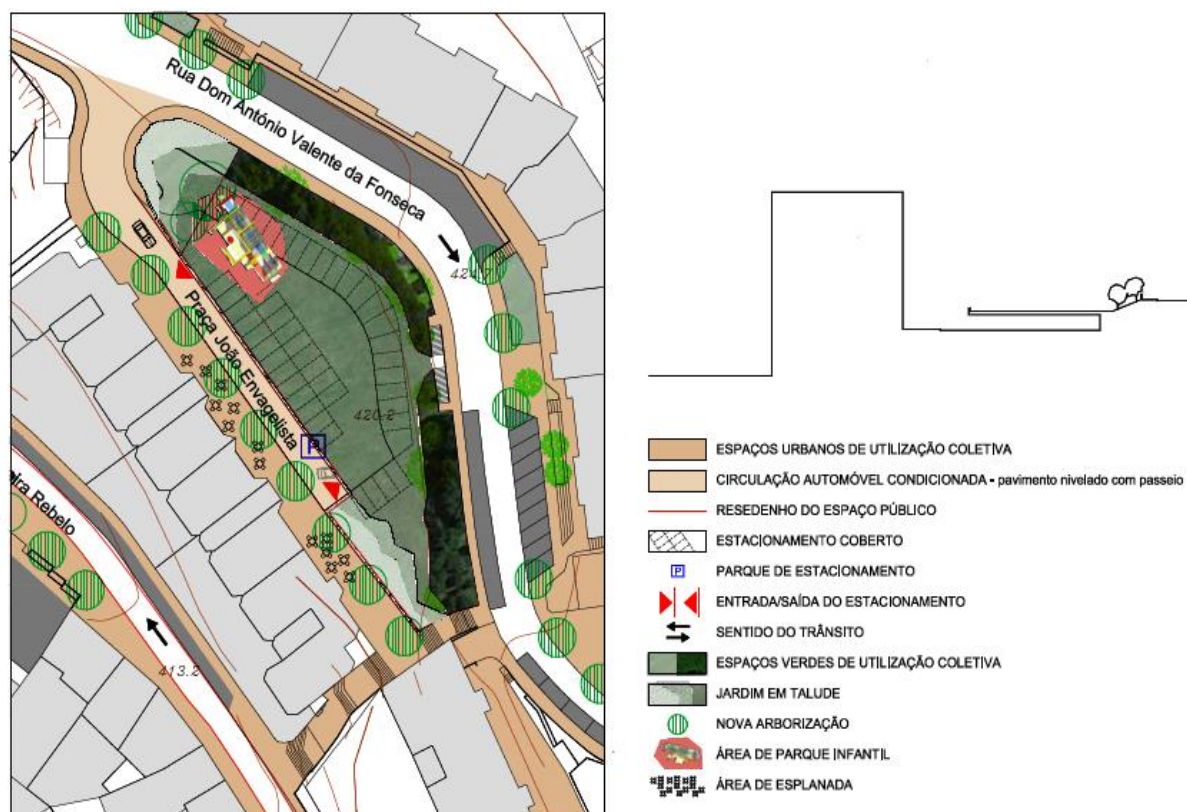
Proposta de reconfiguração da praça João Evangelista
